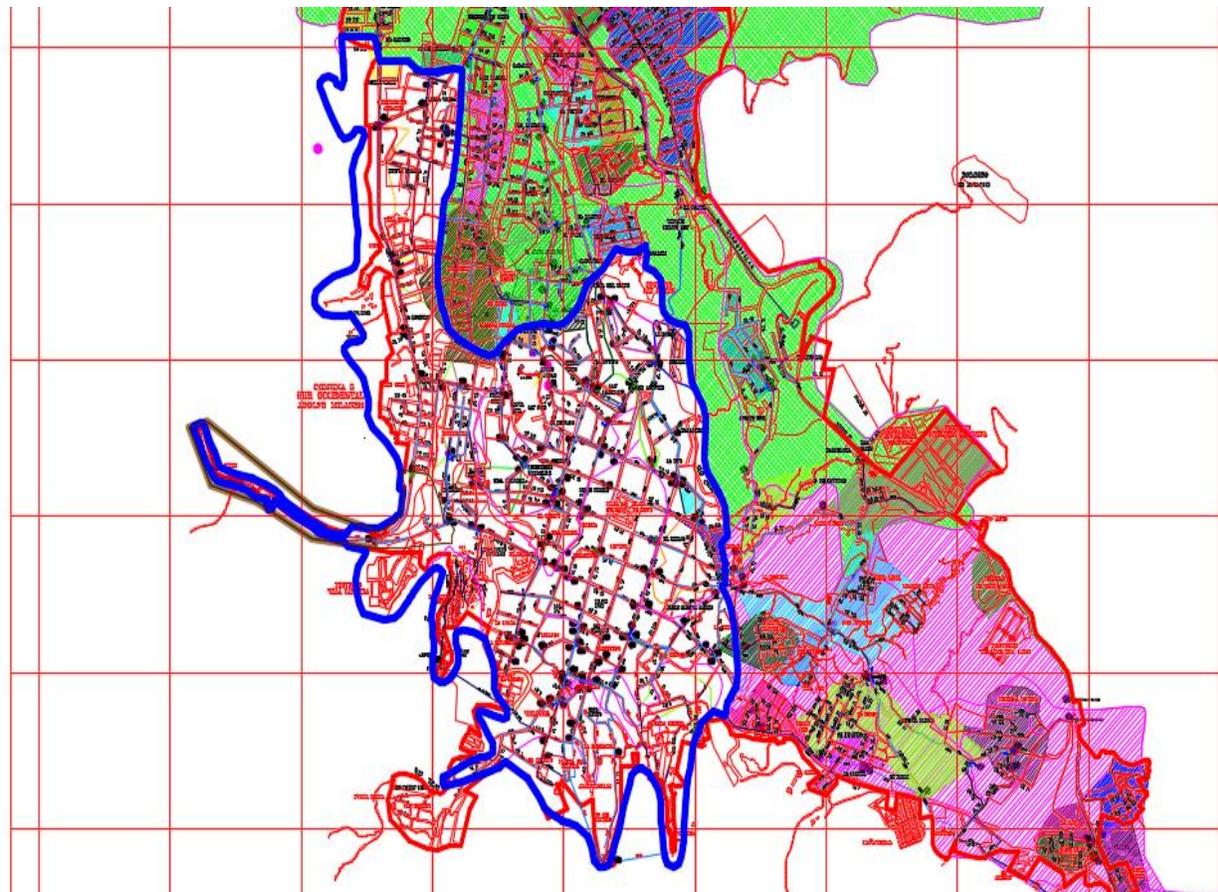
Zona de alimentación, Tanque El Llanito. (Perímetro azul)
